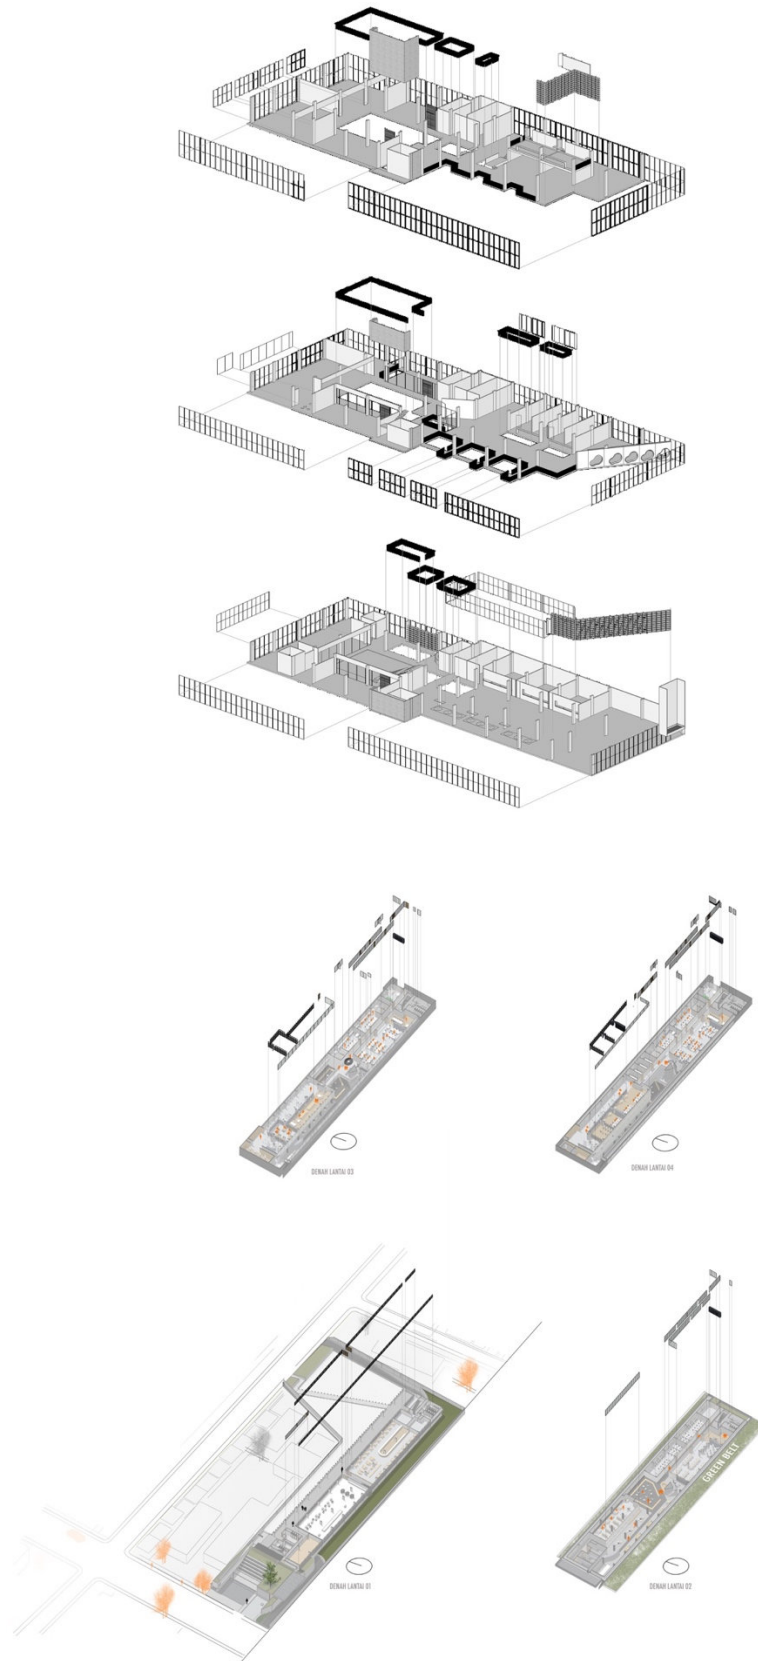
9 Konsep Bentuk Sirkulasi Vertikal Ruang Dalam
